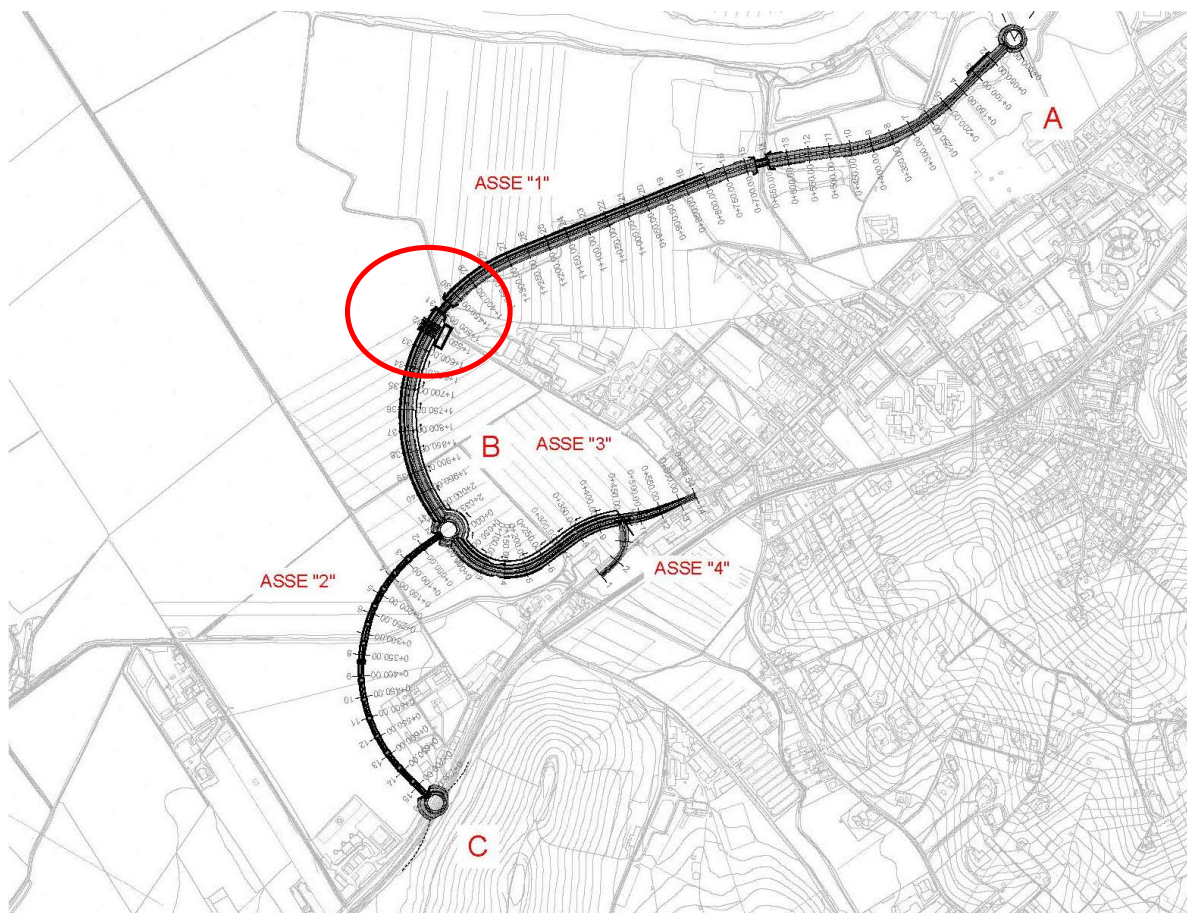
Ubicazione planimetrica del manufatto di attraversamento idraulico.
